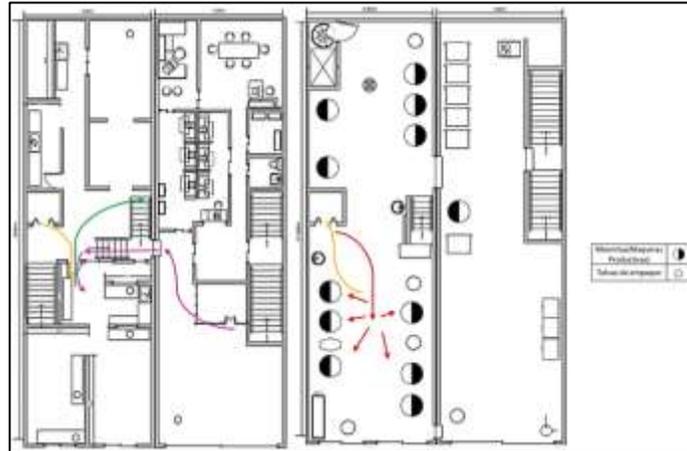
Plano Primer Piso y Mezanine Producto terminado.
